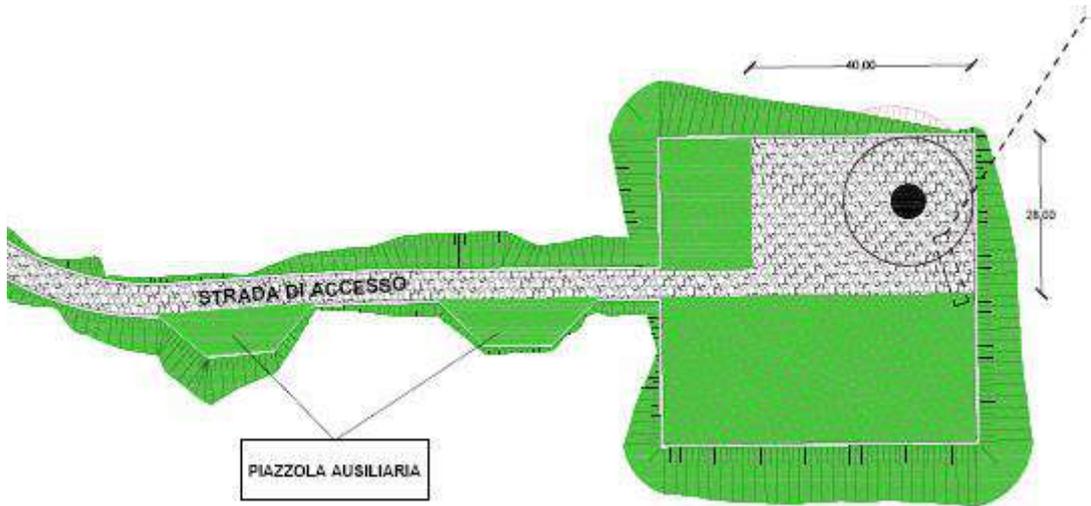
Planimetria piazzola tipo in fase di esercizio
